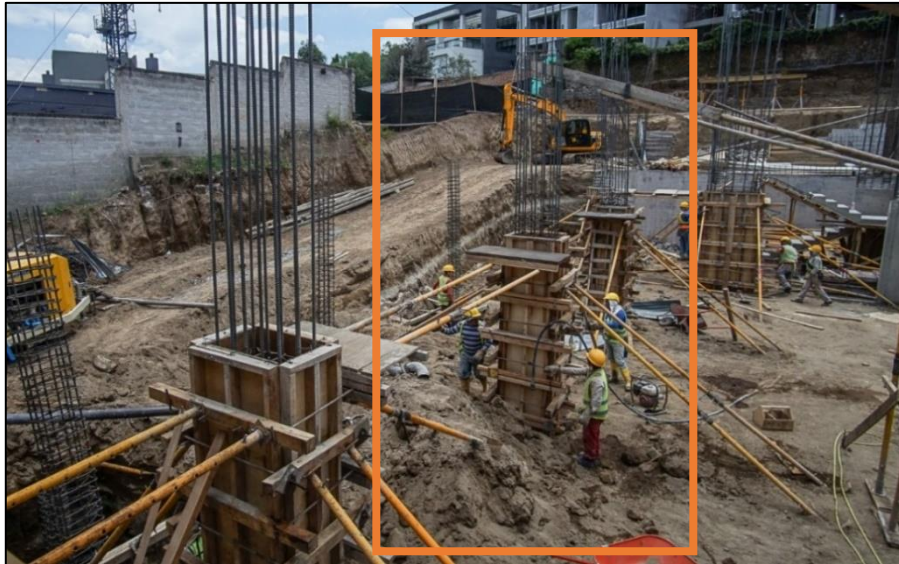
Inicio trabajos vaciado de hormigón en columnas
